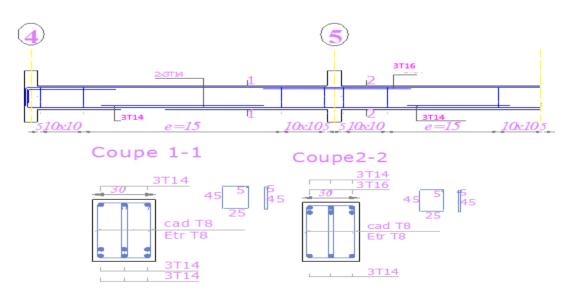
Schéma de ferraillage d'une poutre principale –la plus sollicitée-
